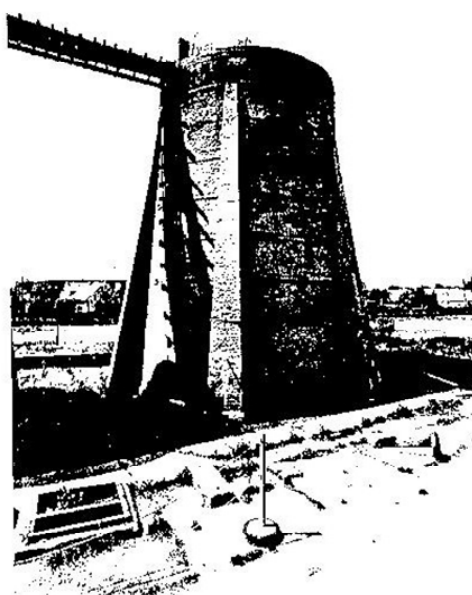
Piec nr 2. Widok od strony zachodniej
